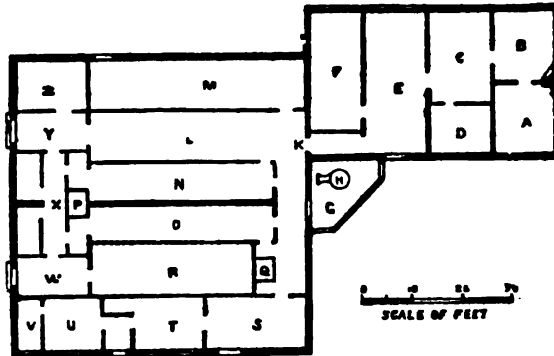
Grundriss der Fabrik von Marion.
